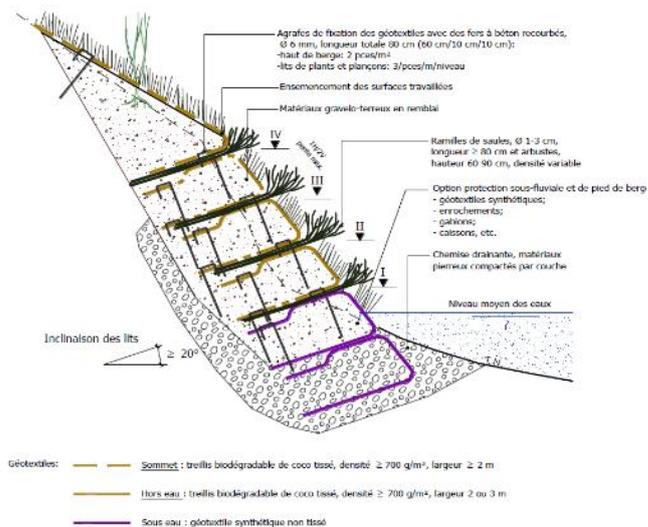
Schéma de principe d'un lit de plants et plançons (source : Biotec)
